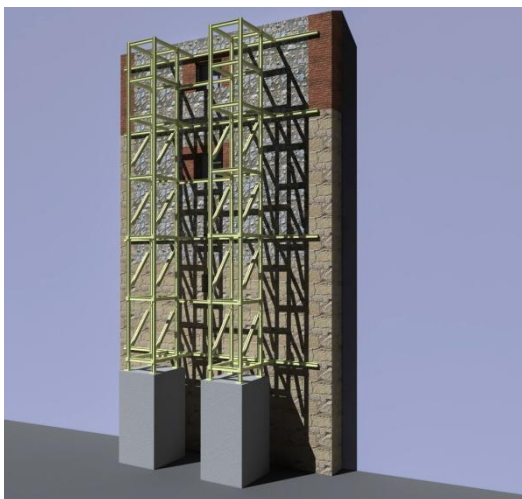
Representación de los estabilizadores en una de las fachadas de la fábrica de harina.
